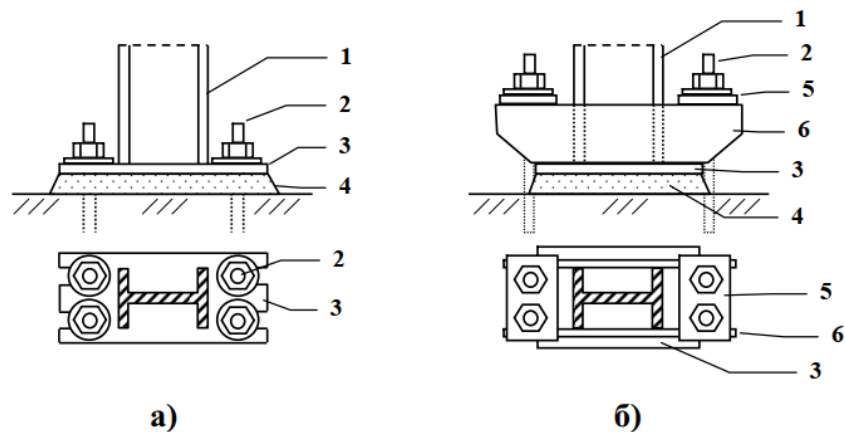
Приклади встановлення на фундамент сталевих колон: а) опорна плита одноопорної колони; б) башмак двохопорної колони 1 – стрижень гілки колони; 2 – анкерний болт; 3 – опорна плита; 4 – бетонна підливка; 5 – анкерна плита; 6 – траверса
